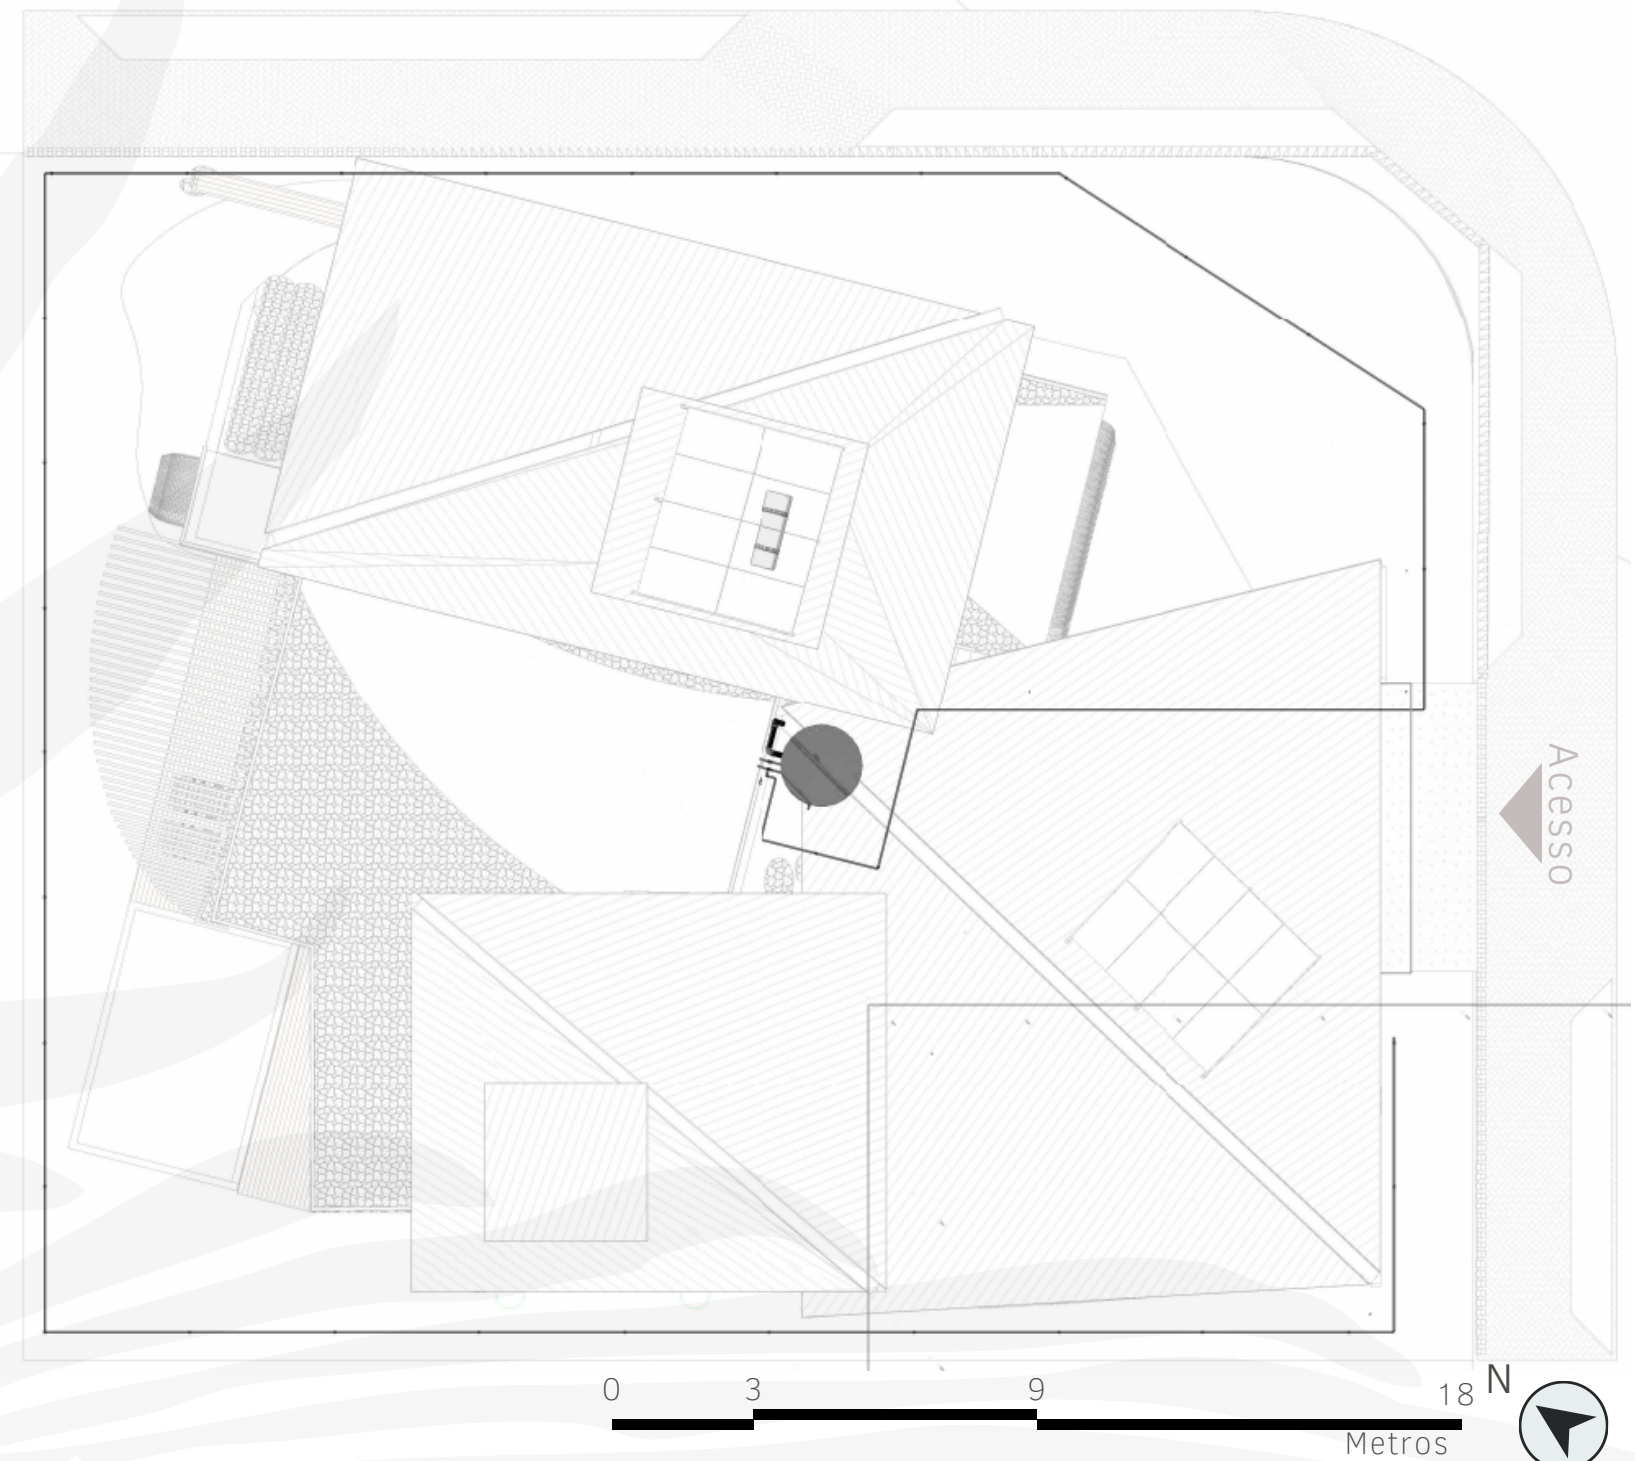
Planta de cobertura com irrigação. Fonte: Elaboração própria da autora.
